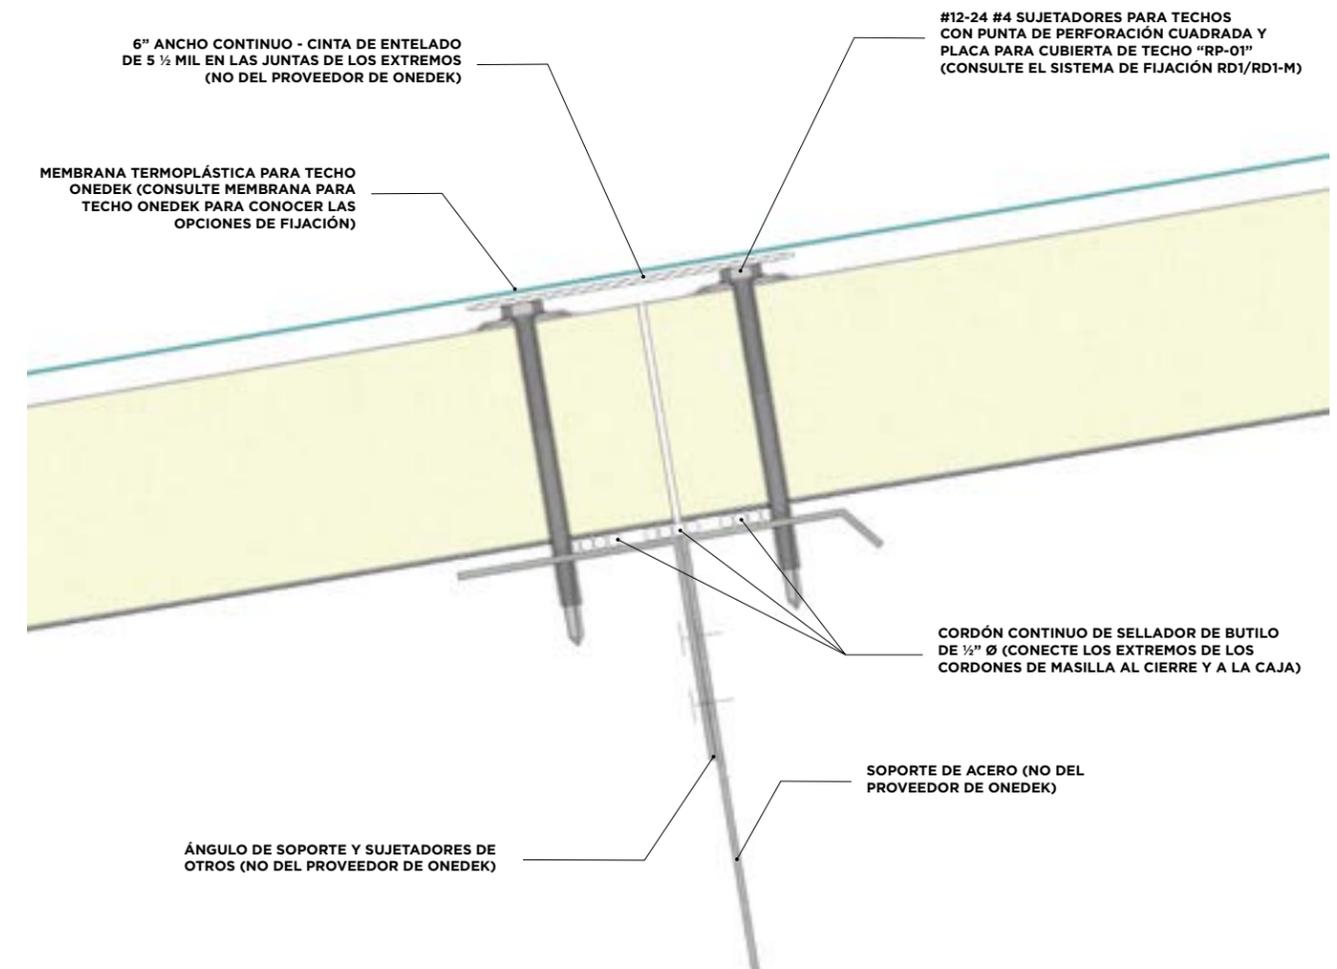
DETALLE DE JUNTA A TOPE (VISTA DE LA SECCIÓN)
